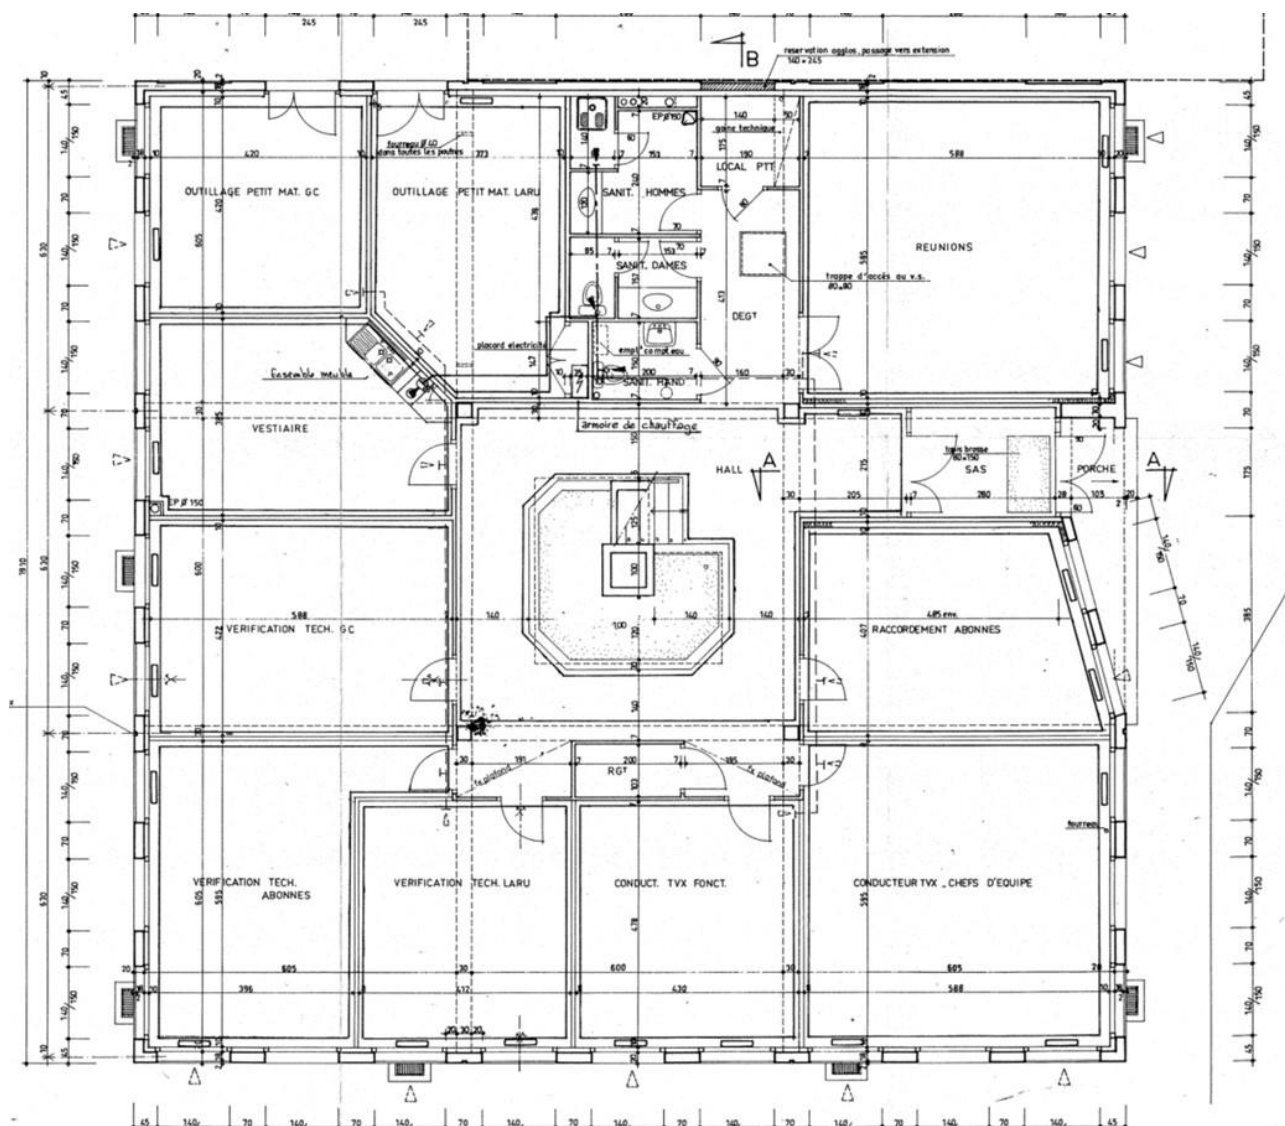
PLAN DE MASSE DU BATIMENT C – PLAN EN DATE DU 10/10/1988
